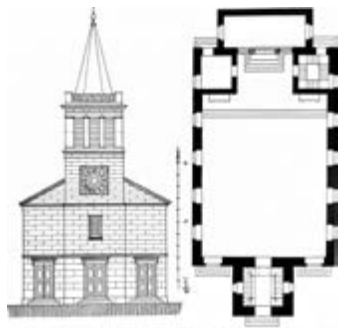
Schinkel, Plan und Schnitt zur Kirche, Ehrenhöhe, nach Entwurf von Schinkel.
